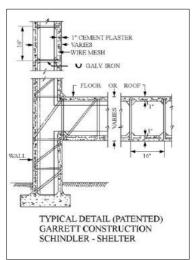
가렛 건설공법 (Garrett construction system) 세부상세
